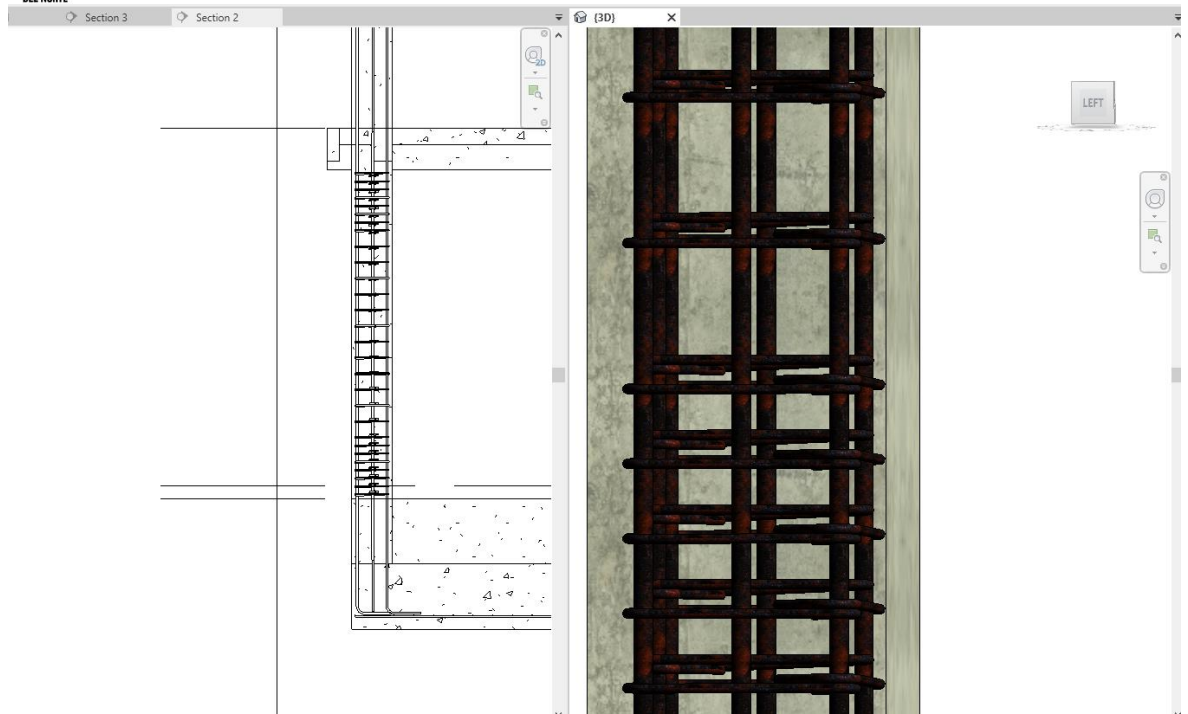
Lado izquierdo Vista Oeste o West en inglés y al lado derecho una Vista 3D de Columna C-1 (Fuente: Elaboración Propia).
